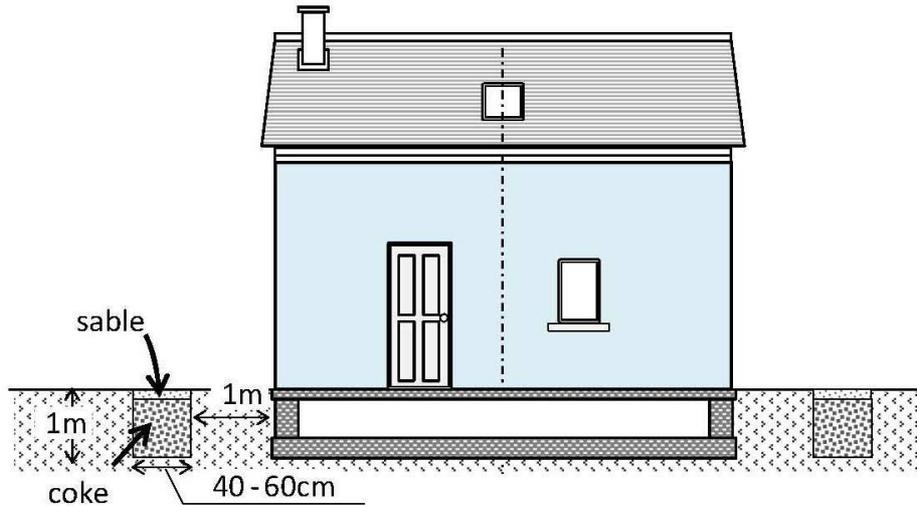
Exemple de tranchée compressible périphérique à l'aide de remplissage de type coke
